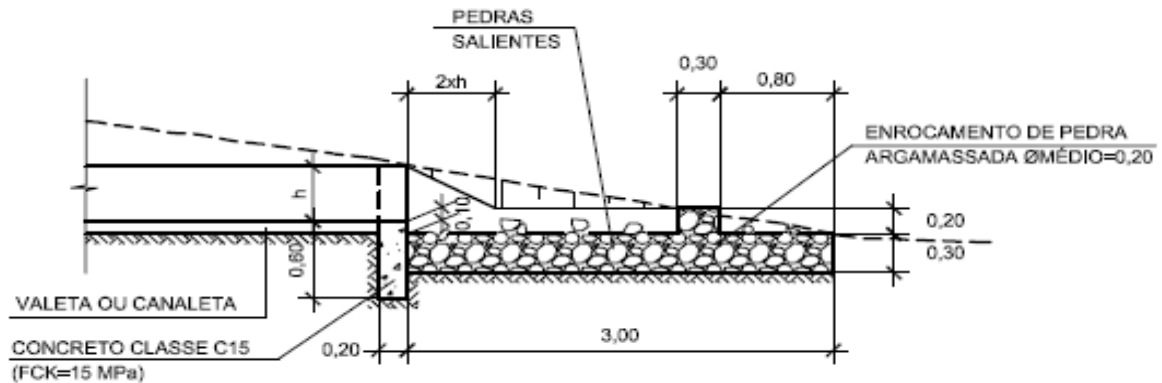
Ala de Saída do canal e do dispositivo de amortecimento.
